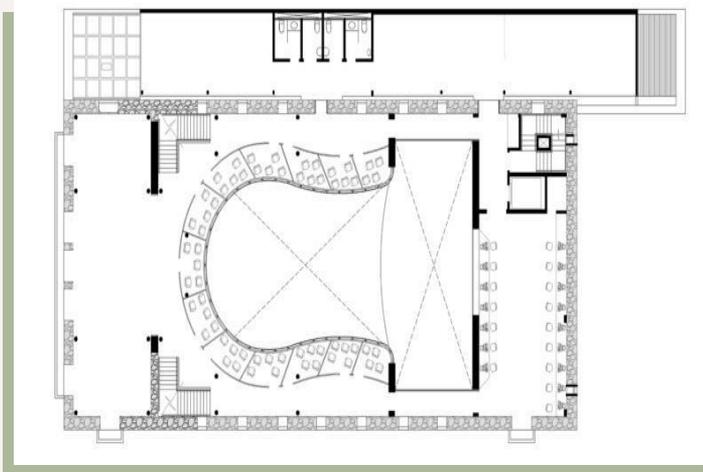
PLANTA 1ºPAV. DO PROJETO DE RESTAURO DO TEATRO GUARANY.
